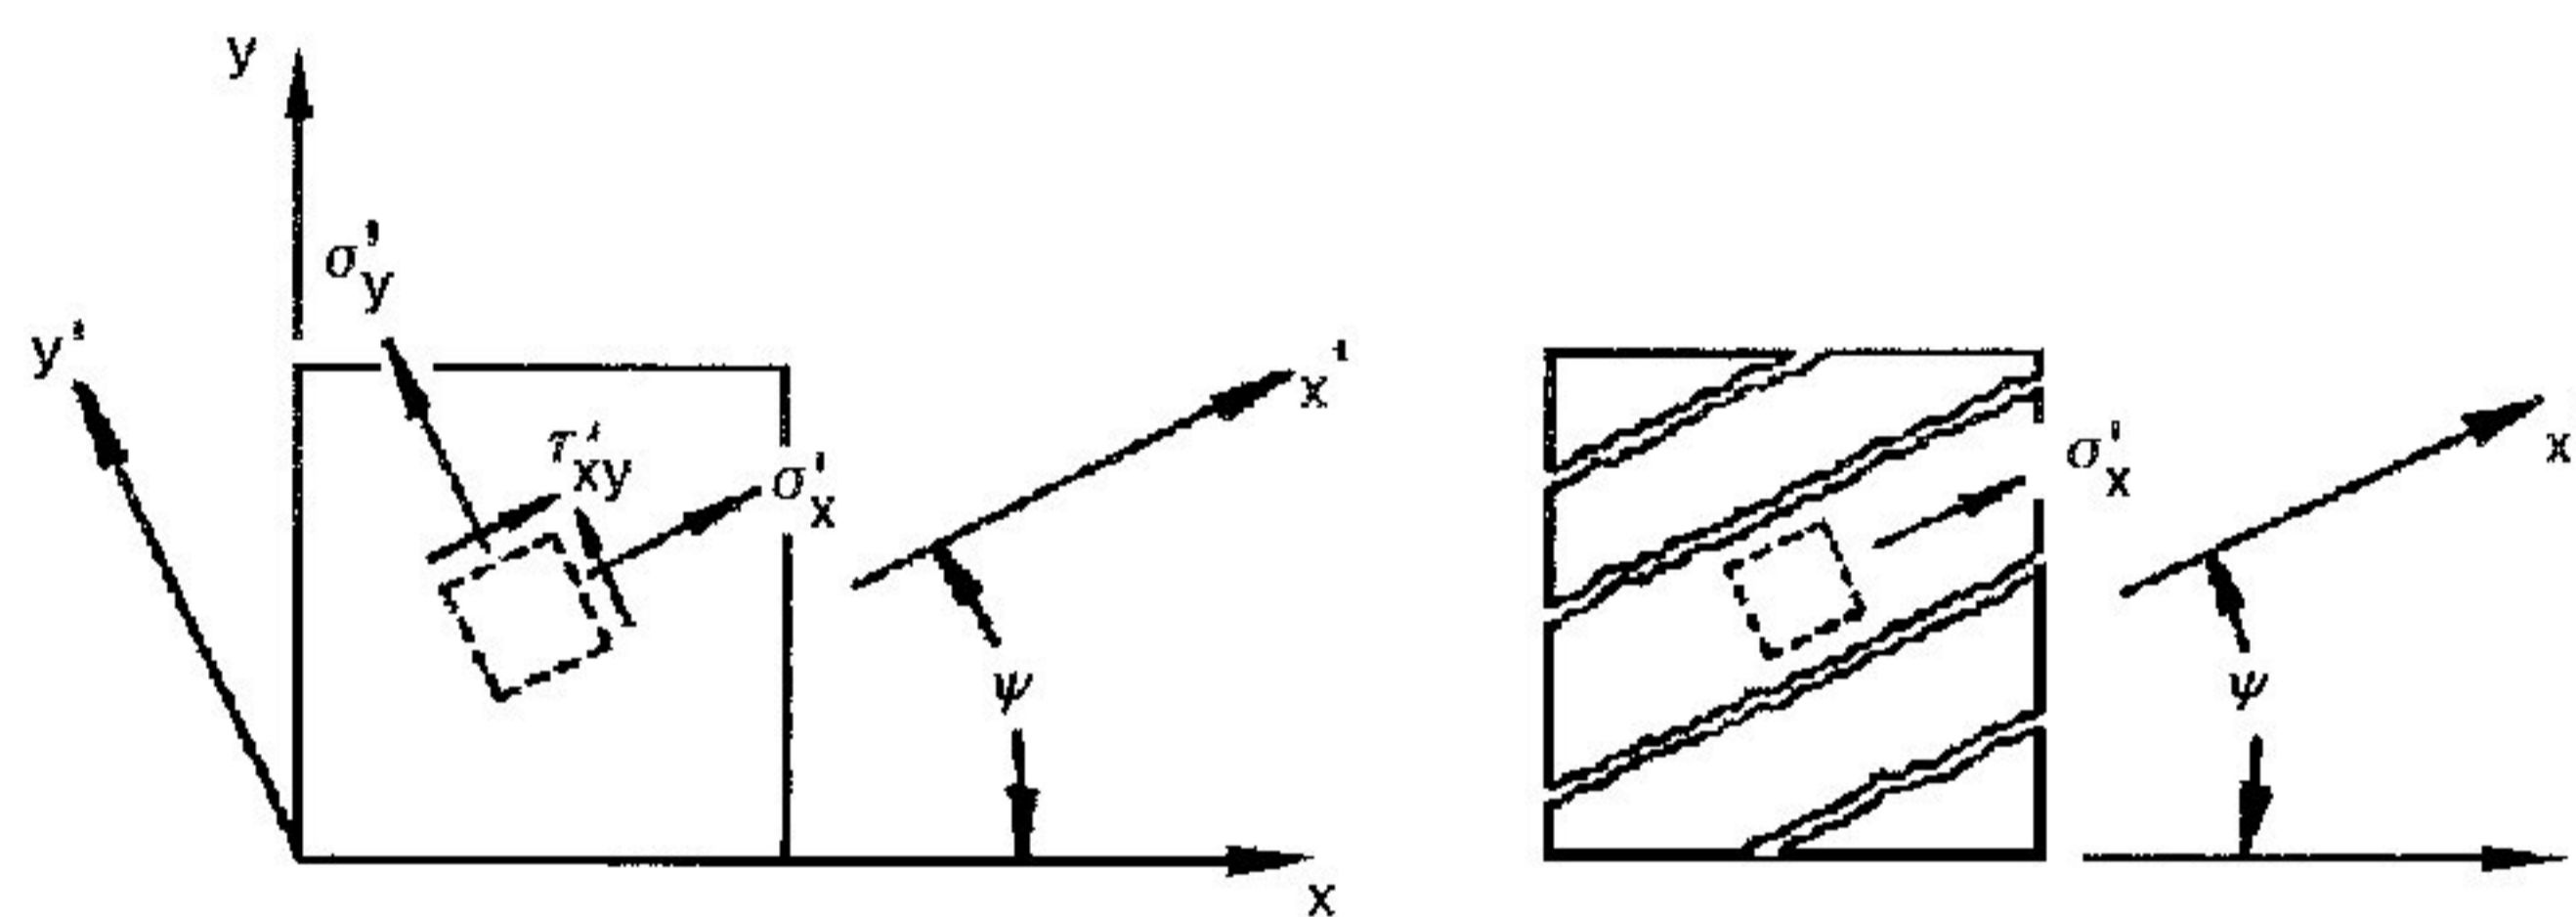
Modelo de fissuras e distribuição de tensões no concreto fissurado
